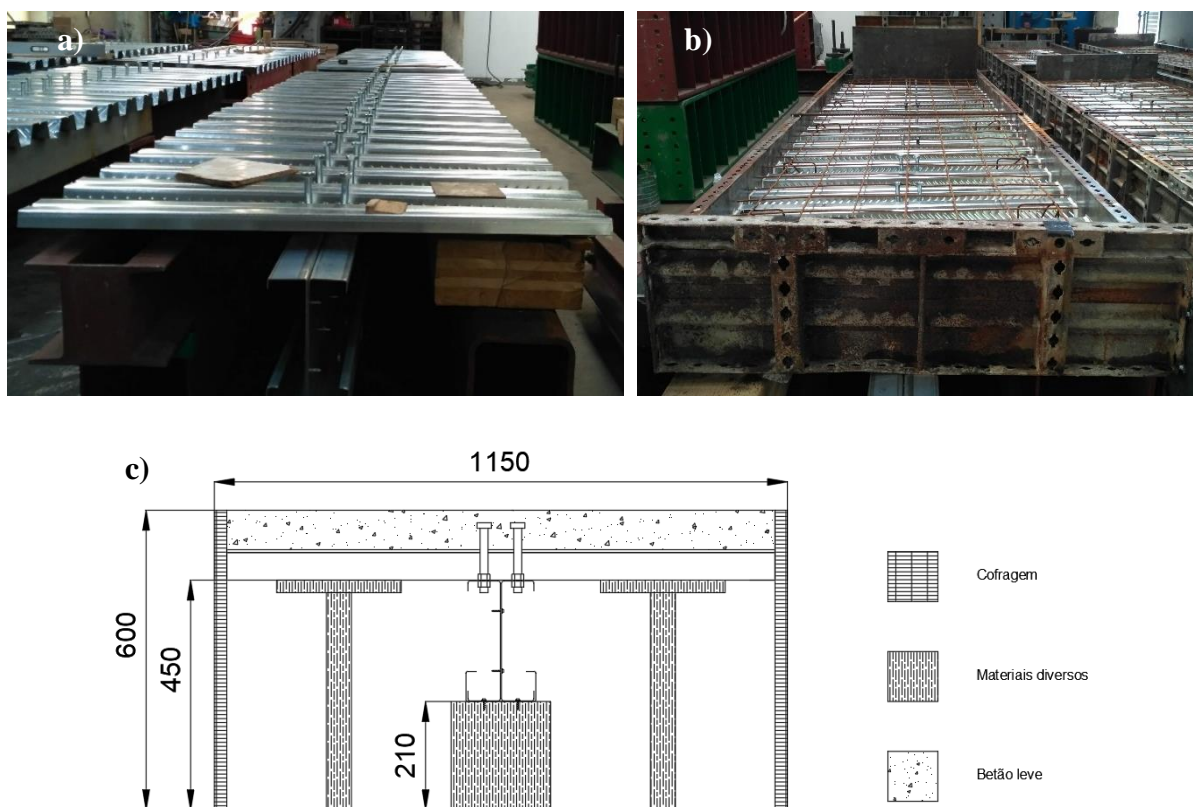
a) Laje nivelada antes da cofragem. b) Laje com cofragem e armadura mínima e de flexão negativa. c) Esquema de preparação da cofragem.
